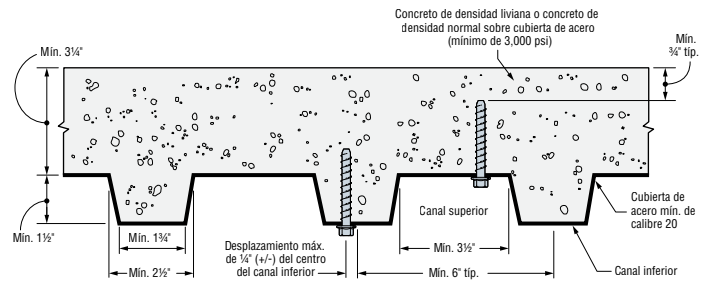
Instalación de anclajes de 1/4" de diámetro en el plafón de concreto sobre cubierta de acero
